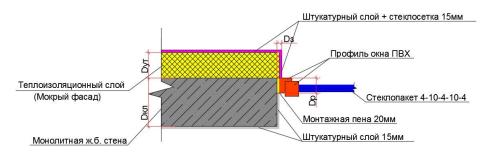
Монолитная стена с наружным утеплением типа мокрый фасад Для рамы $d_{\rm p}$ =60мм
